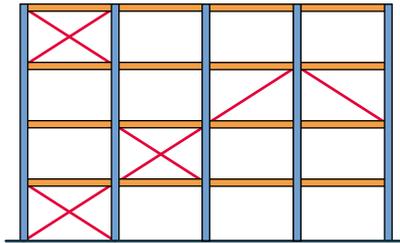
Diagonales de contreventement placées dans des travées différentes.
